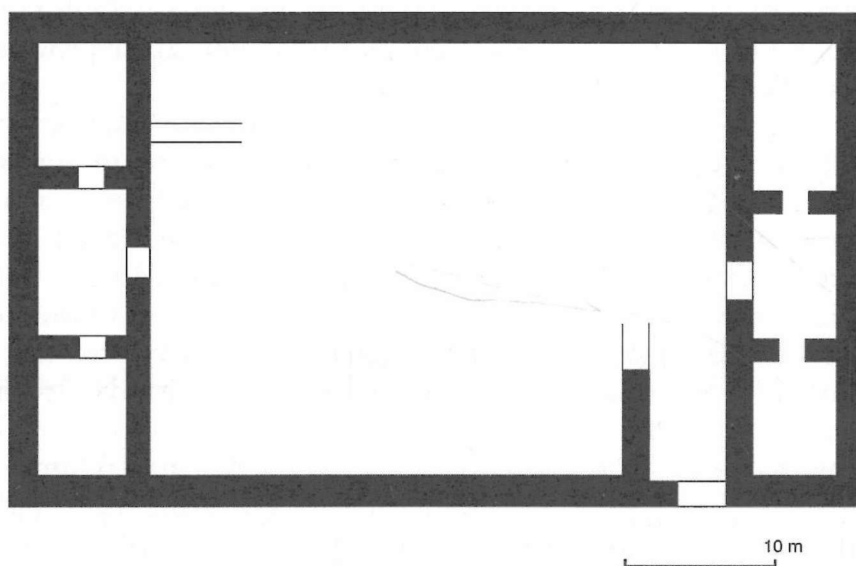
Monte Castello di Procchio. Planimetria generale.
